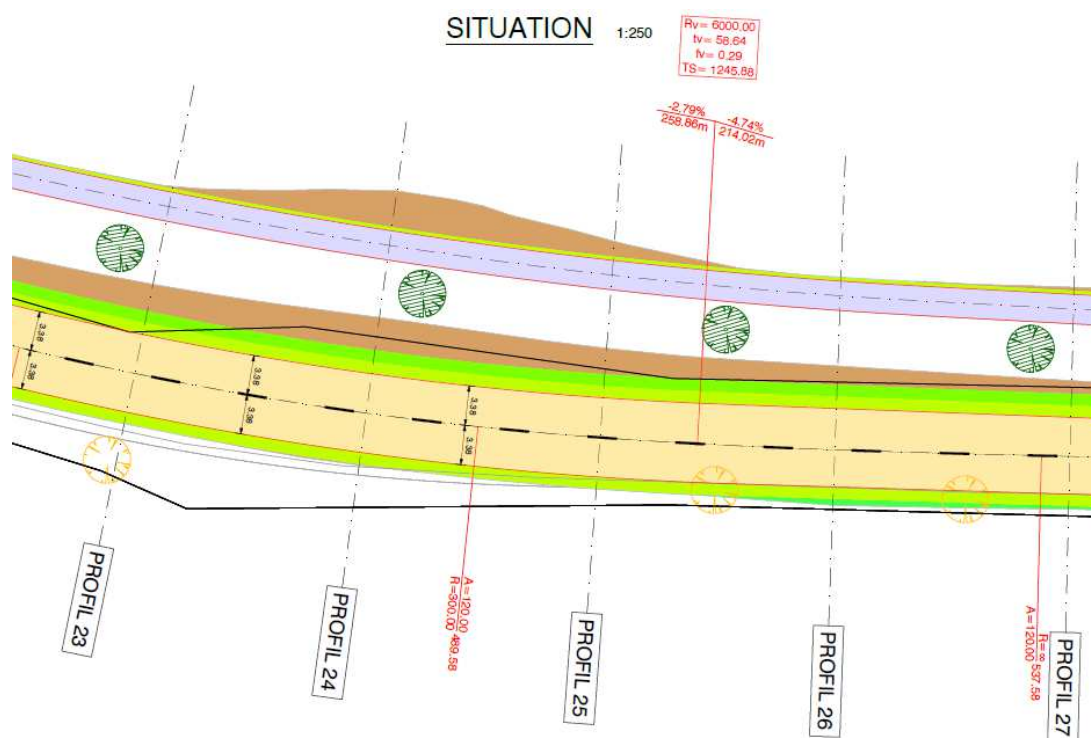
alignement d'arbres futurs à l'amont de la route, entre cette dernière et la piste mixte
